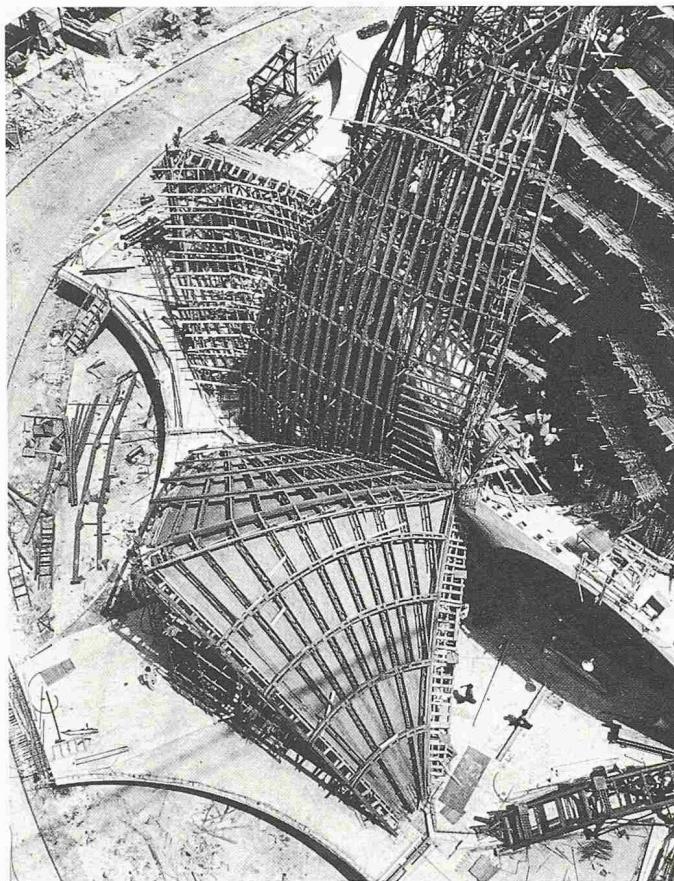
Das gekrümmte Stahlgerüst der «Äusseren- und Ein-gangsblätter», das von Hand errichtet wurde
